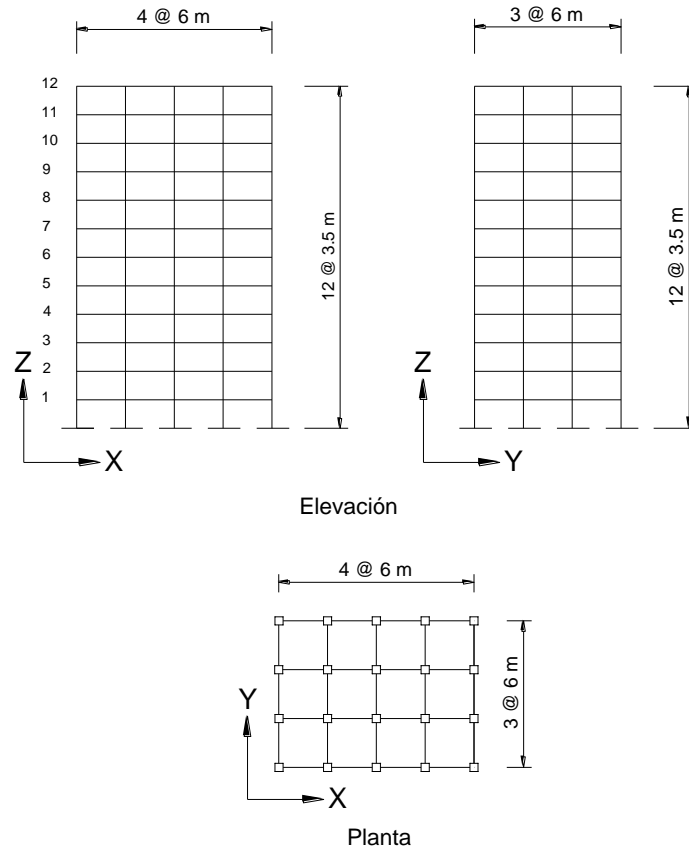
Configuración geométrica de los edificios en planta y elevación
